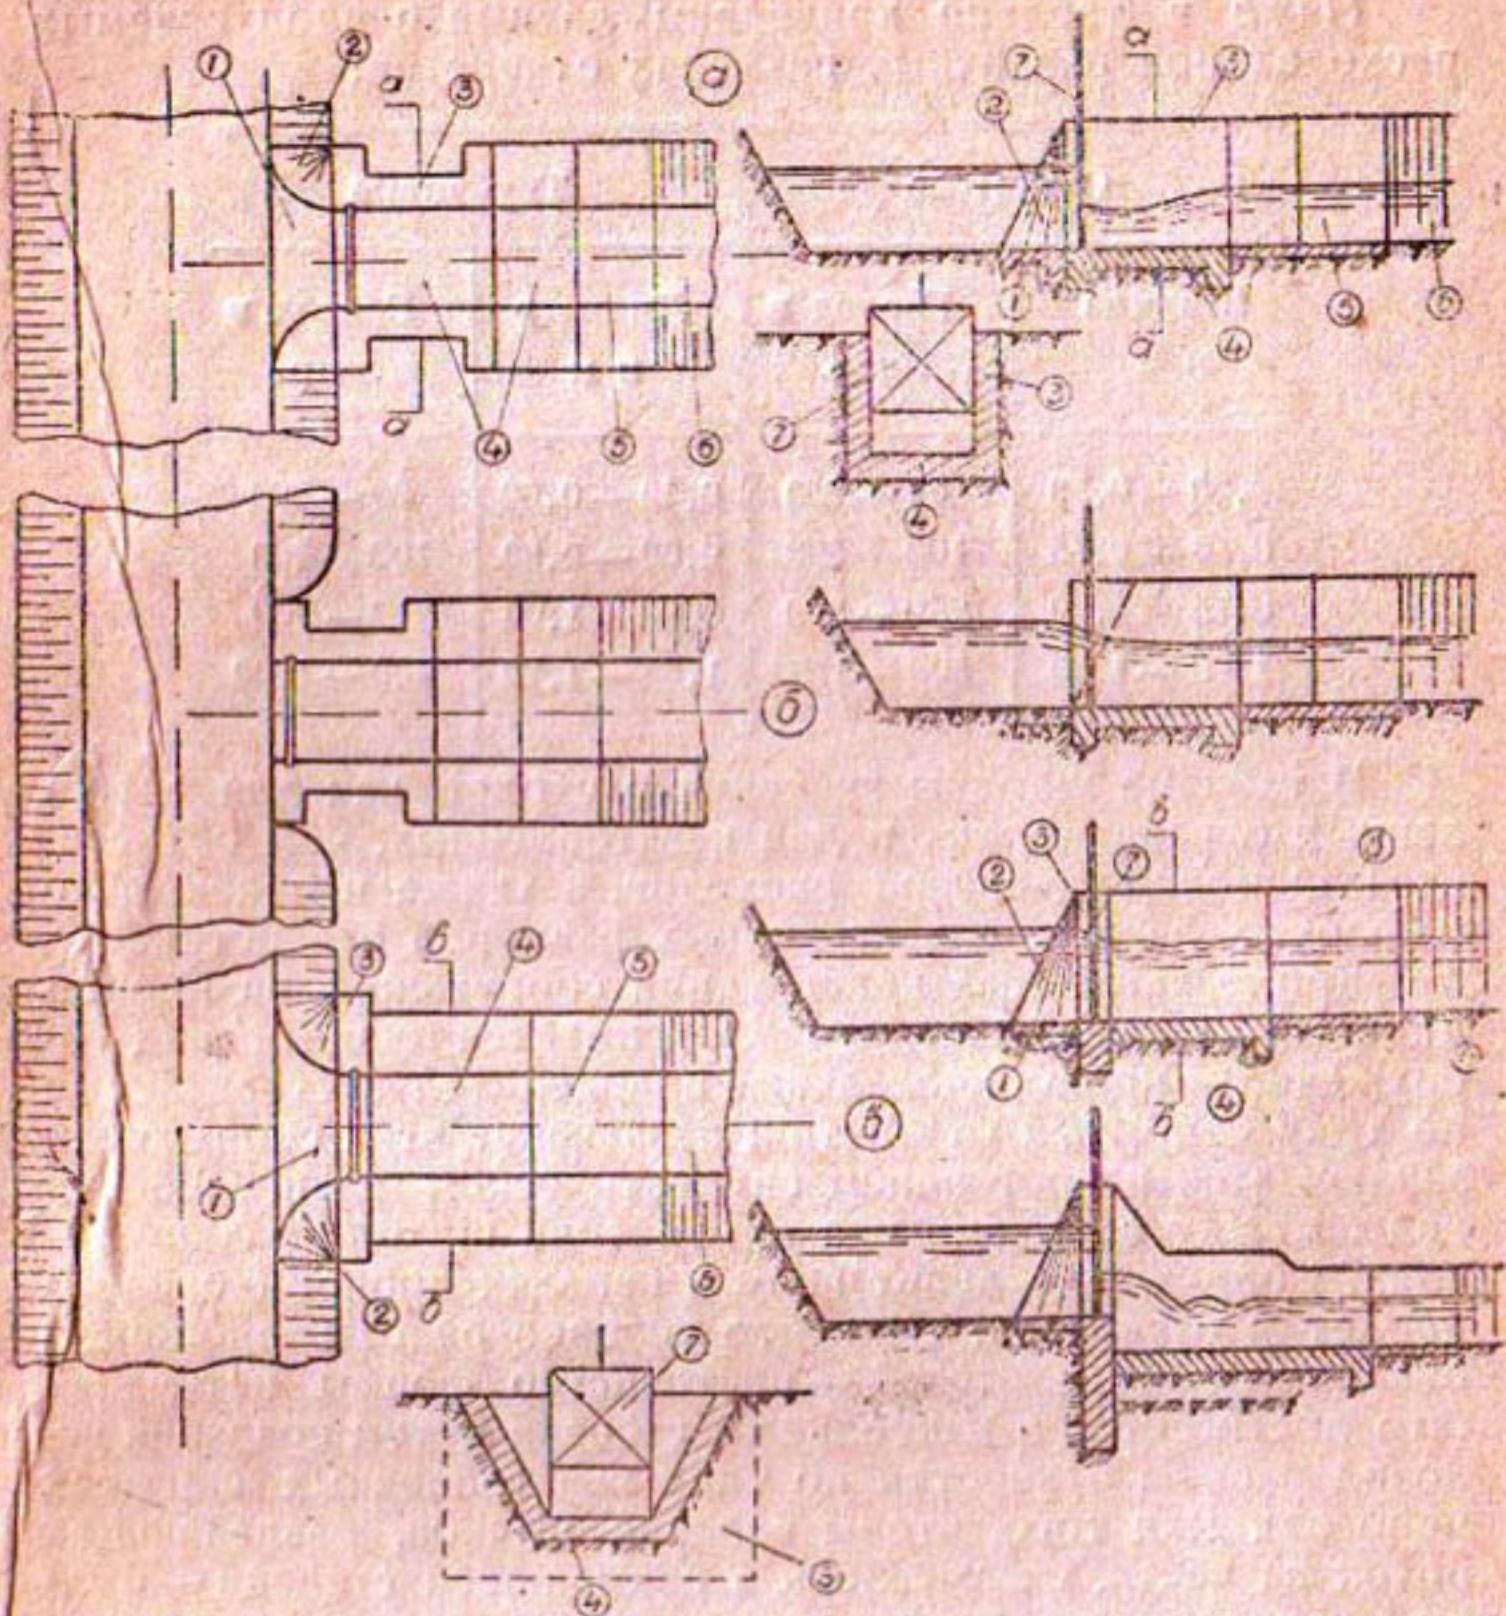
Понур; 2—конуса; 3—подпорные стенки; 4—водобой; 5—рисберма (слив); 6—земляное русло канала; 7—щит.
